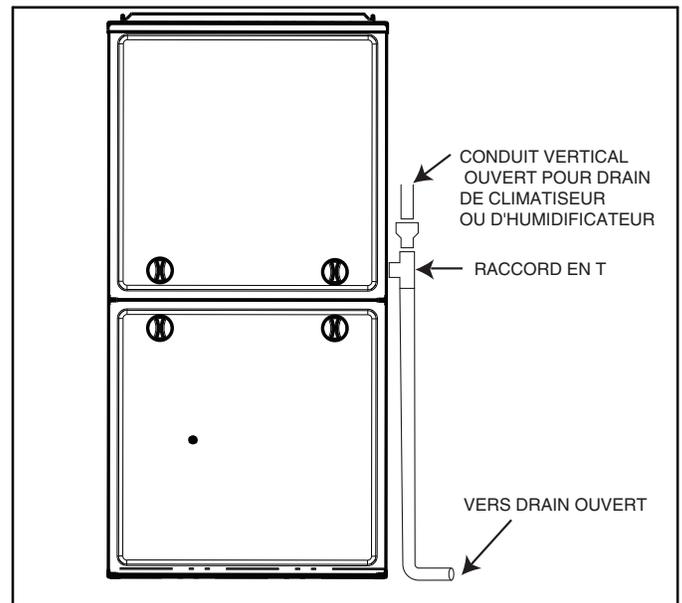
Exemple de fixation au tuyau d'évacuation sur place
